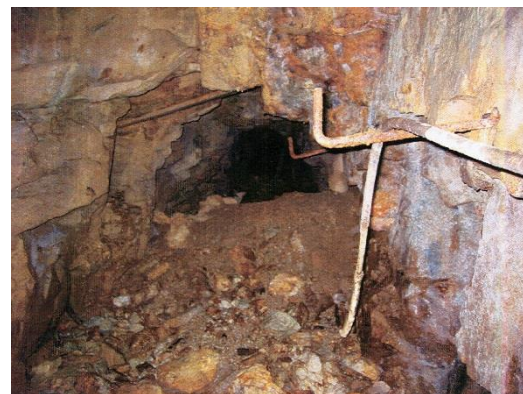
Estado actual del socavón principal de acceso (galería 400)
